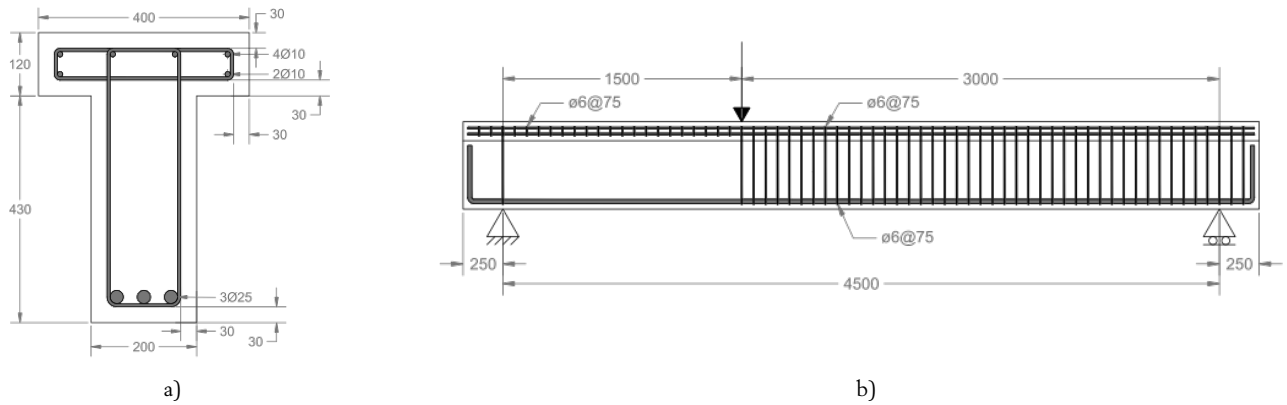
Geometría de la viga: (a) sección transversal, y (b) vista longitudinal (dimensiones en mm).
